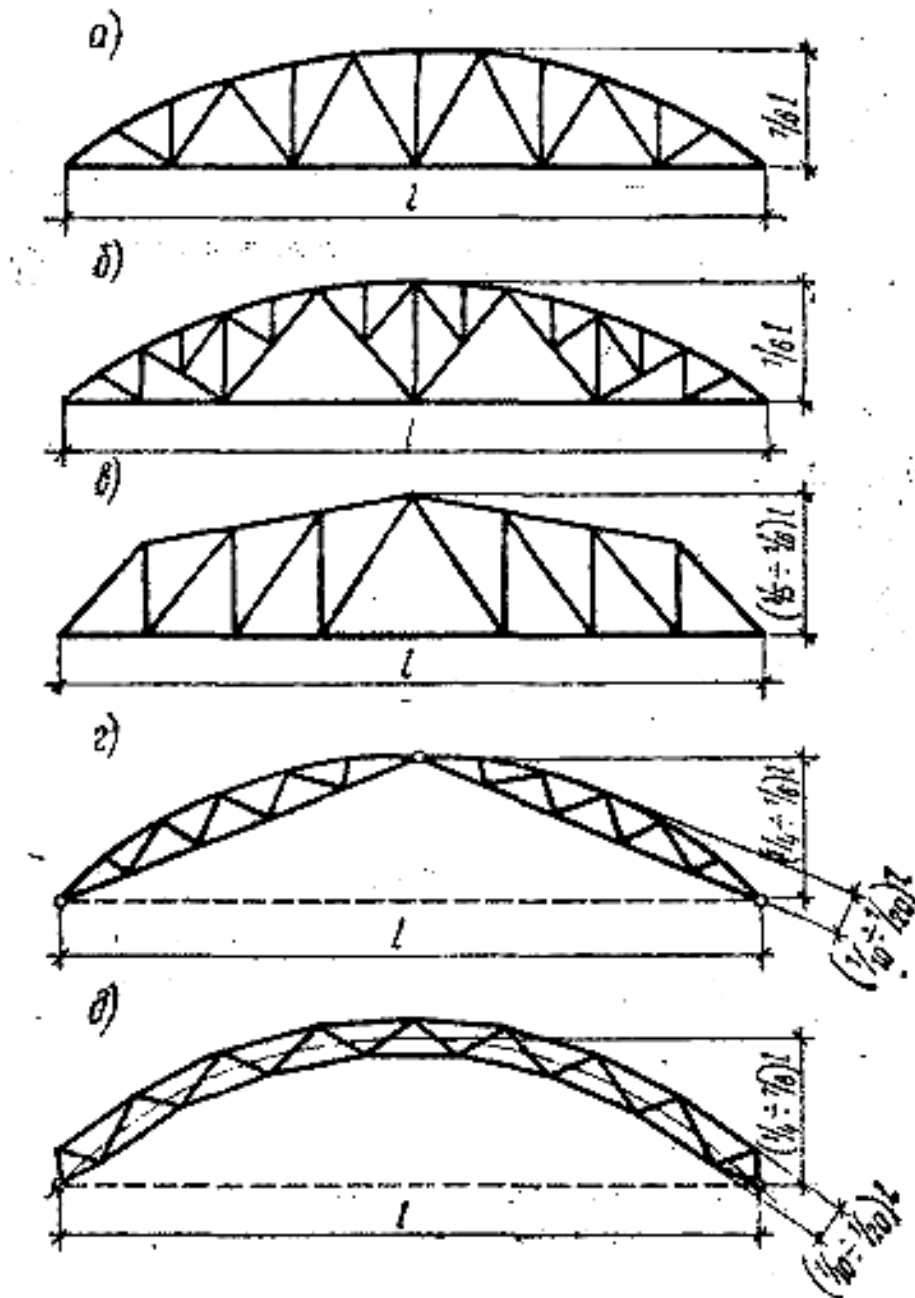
Схеми стрижневих конструкцій із труб: а, б, в – ферми;
